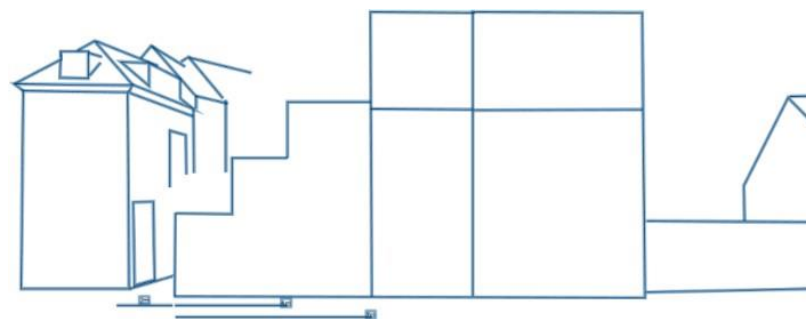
Bouwhoogte in voor- en achtergevelrooilijn en daartussen.
